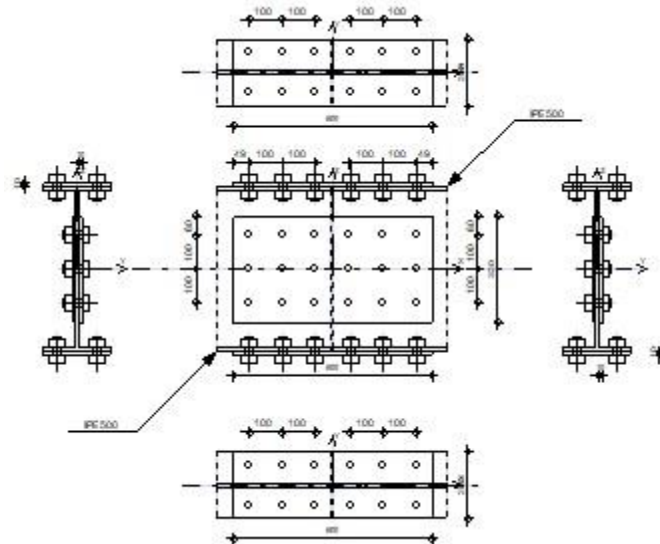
Vue de l'assemblage Poteau plancher – Poutre maitresse
